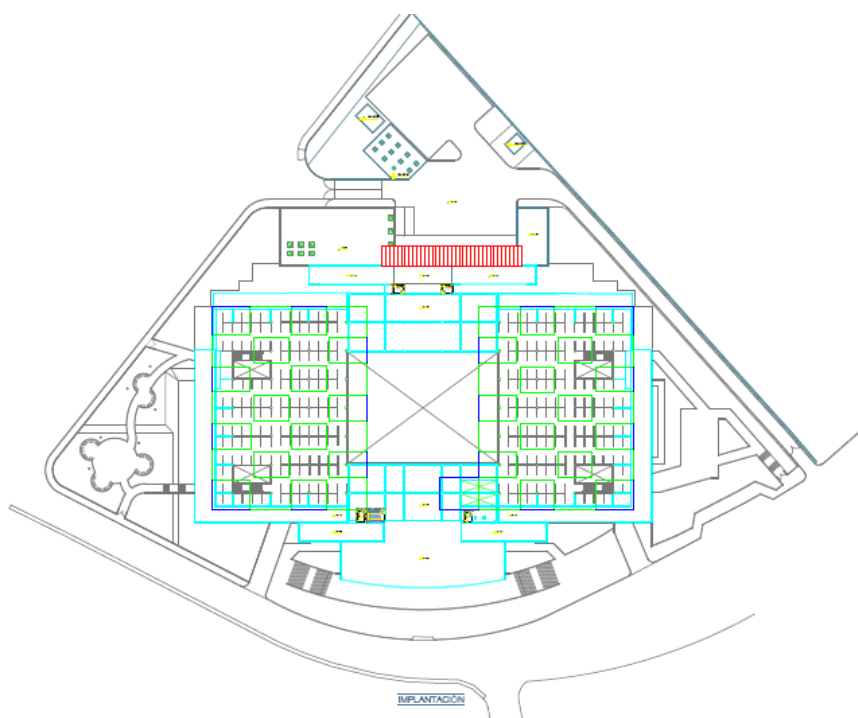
Planta Cubierta Nuevo Mercado 24 de Mayo
